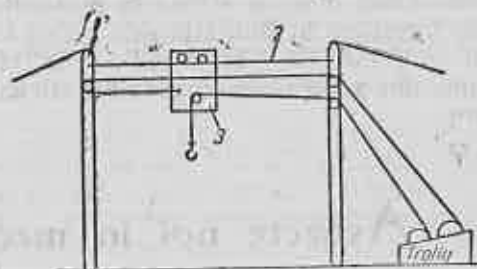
Macara cu cablu acționată de troliu TL-3.
